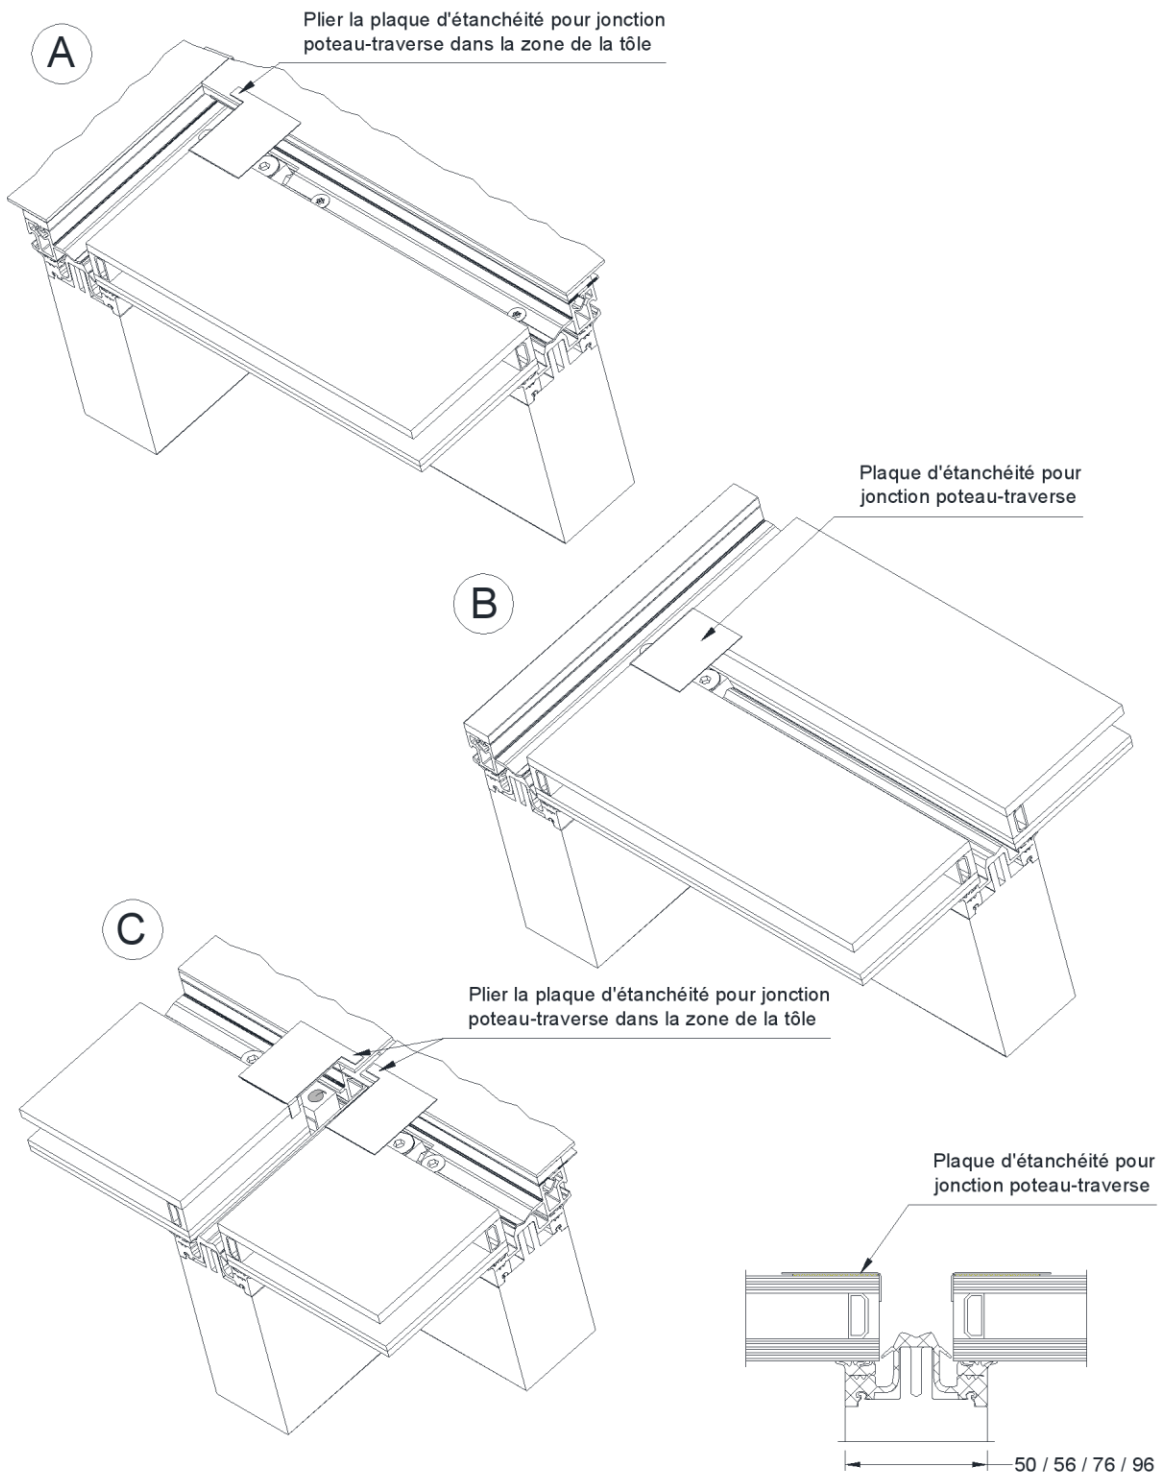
Montage des plaques d'étanchéité pour jonction poteau/traverse à 90°
